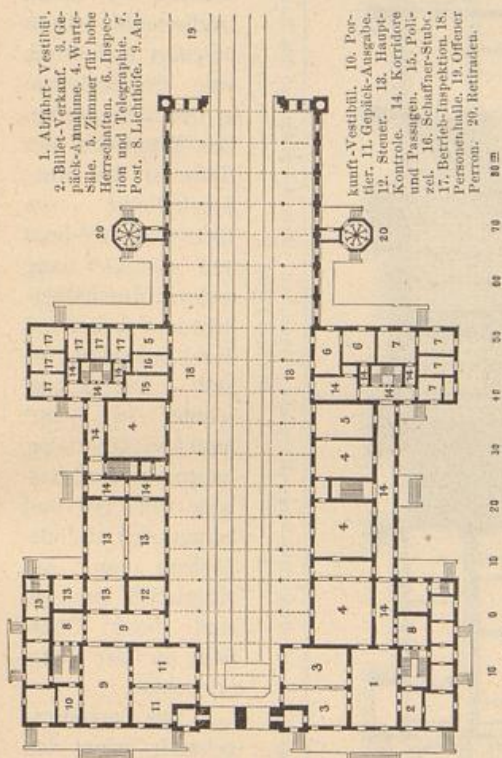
Grundriss des Empfangsgebäudes. (Maasstab 1:1250.)
